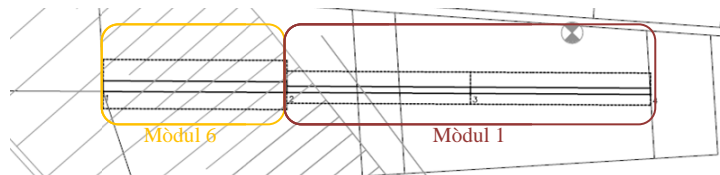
Plànol núm.18.1 full 7 Mur 6 planta.
